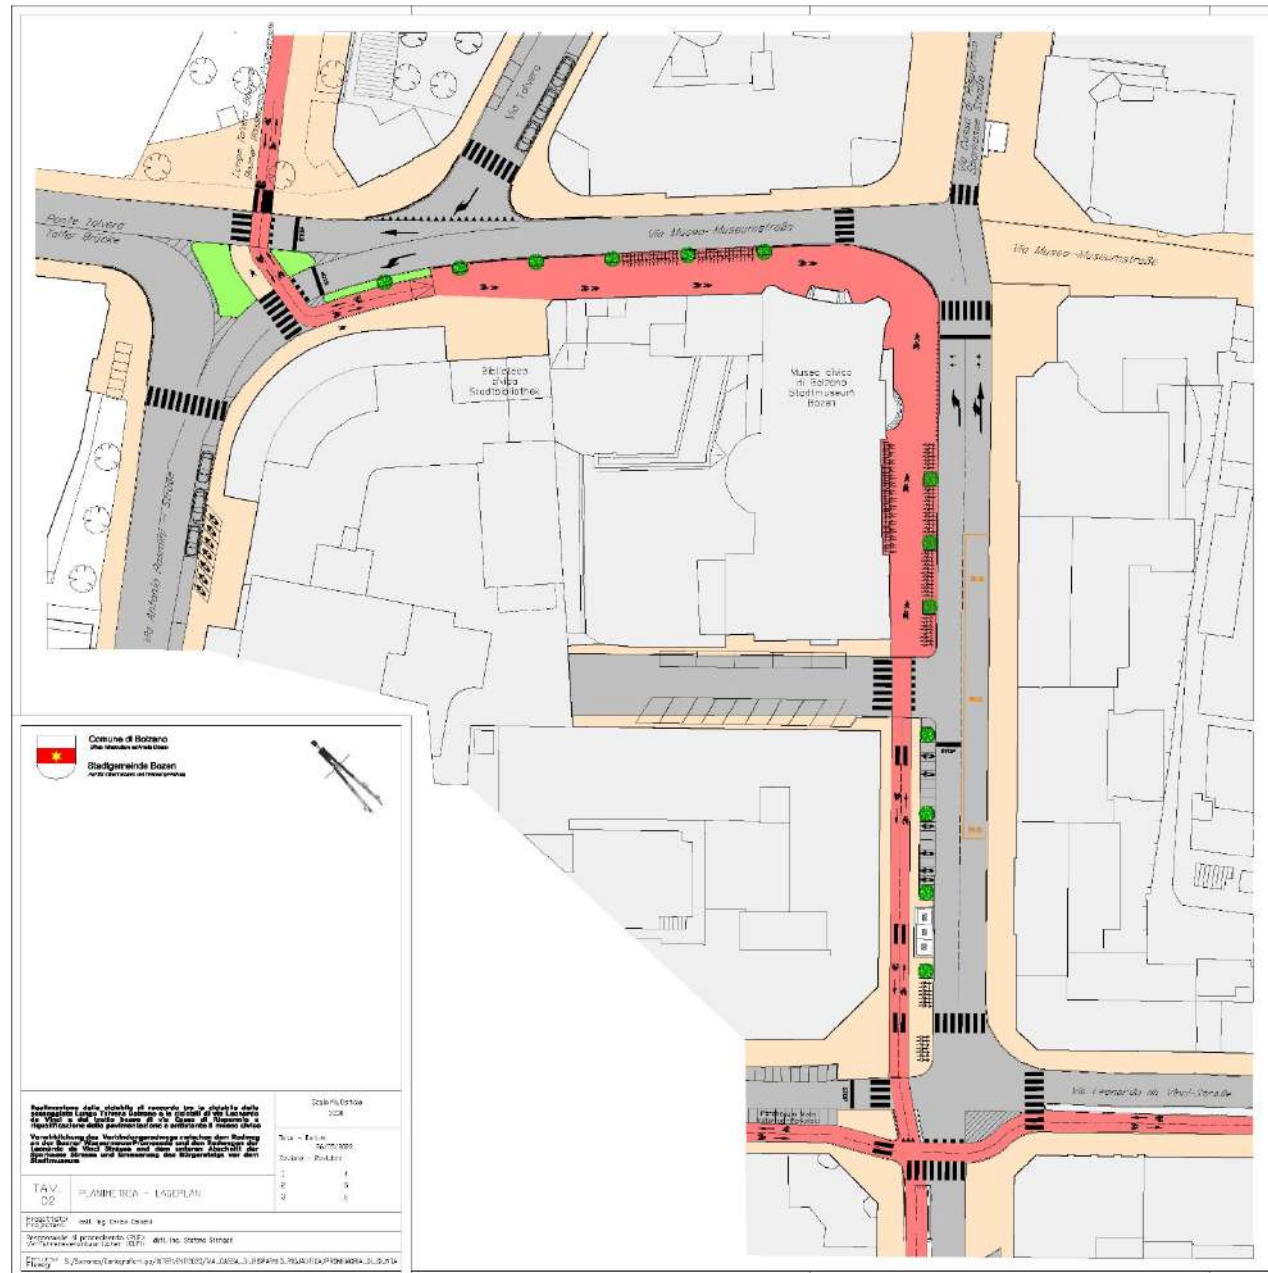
Radweg in der Sparkassenstraße und Museumstraße (6) - Lageplan
